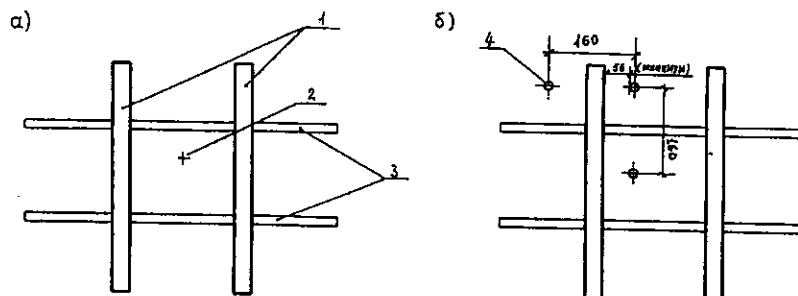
Схема определения положения арматуры и места установки анкера а — положение арматуры; б — расположение отверстий для дюбелей; 1 — вертикальная арматура; 2 — предполагаемое место установки анкера; 3 — горизонтальная арматура; 4 — отверстие диаметром 16 мм для дюбелей
